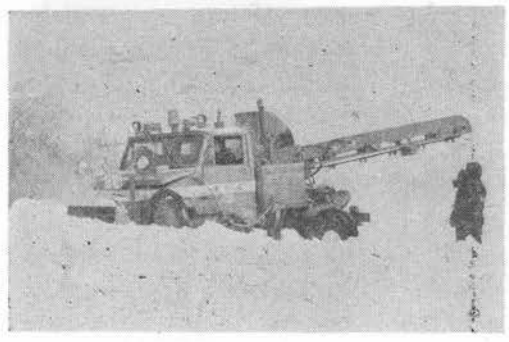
スノーローダ (SL-4 型 2 W 400 搭載)
